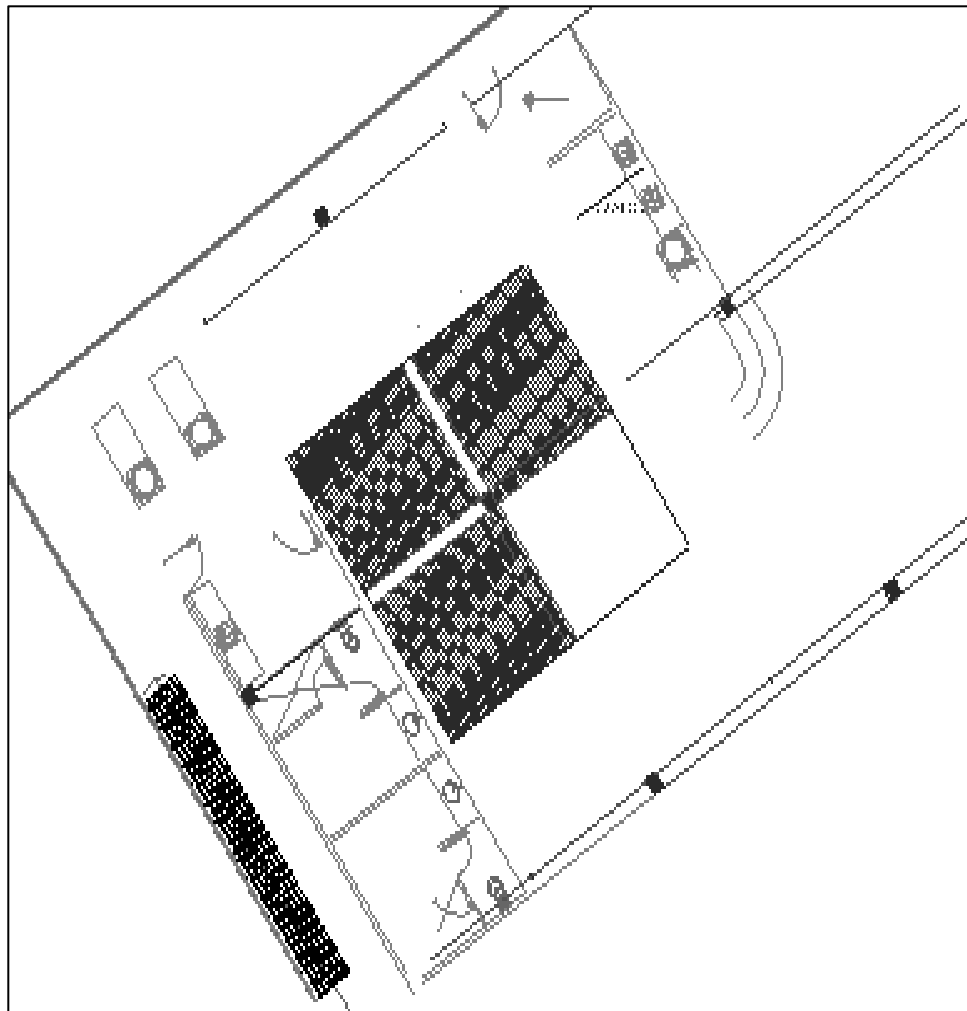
Plano estructuras restaurante, columnas. (Fuente: Elaboración Propia)
